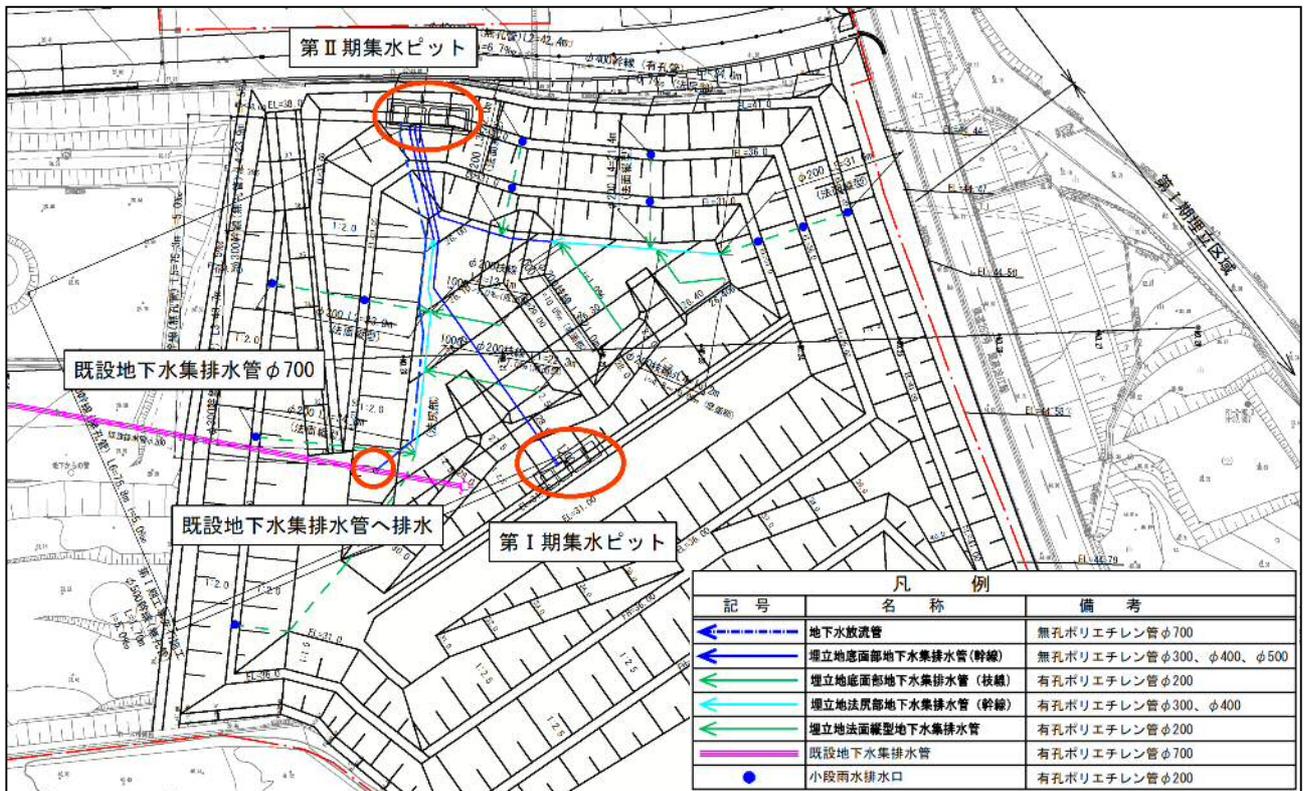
地下水集排水施設布設計画平面図 (第Ⅱ期)
